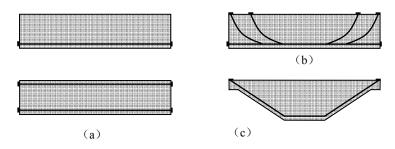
预应力钢筋的布置 (a) 直线形;(b) 曲线形;(c) 折线形
